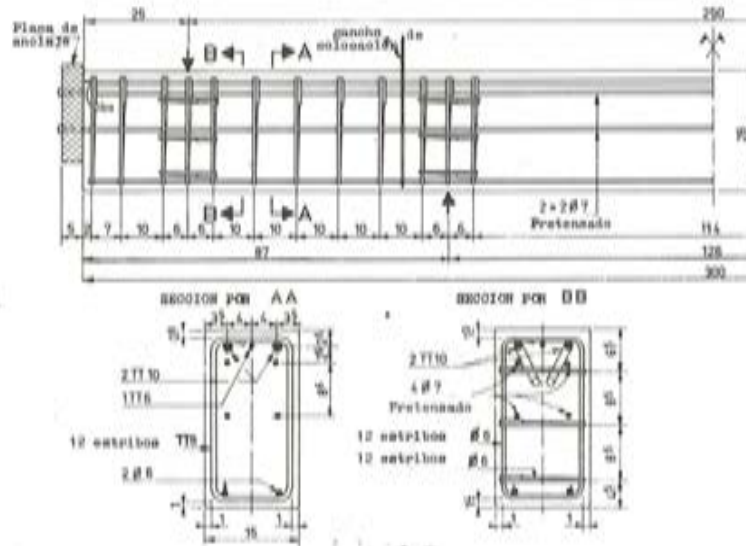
Armaduras de las viguetas A3 y A3'.
